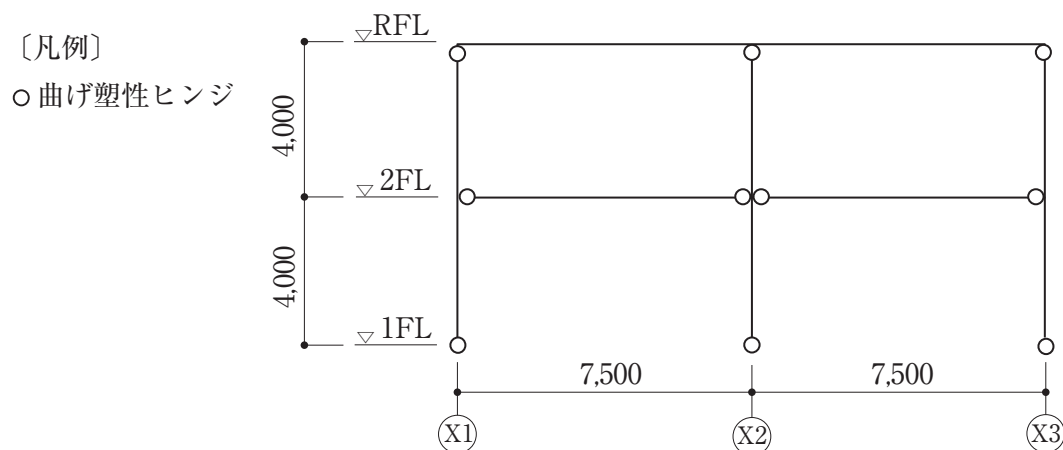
曲げ塑性ヒンジ発生位置(単位：mm)
